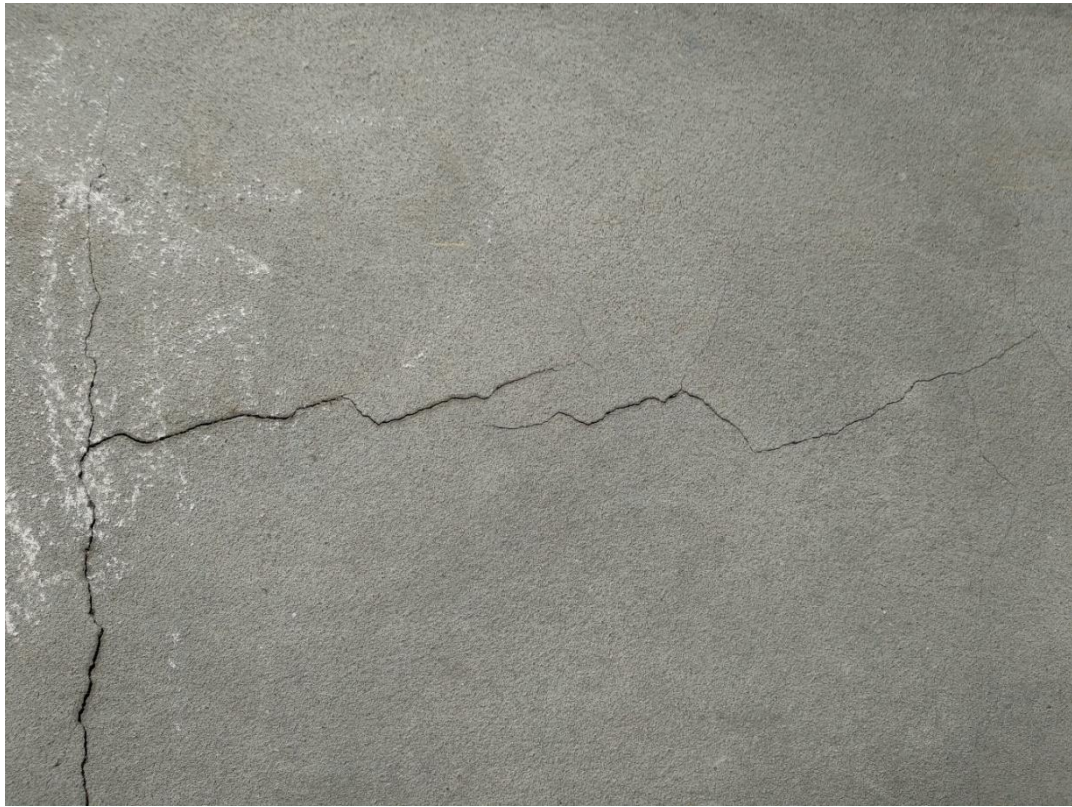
Imagem 5 (Original, Fissuras, Unidade Hoteleira)
